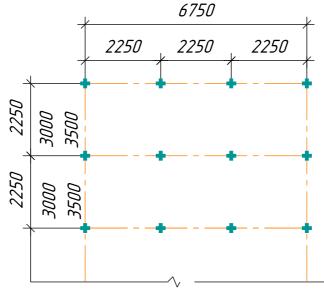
Схема плана свайного поля (точное расположение свай определяется расчетом)
